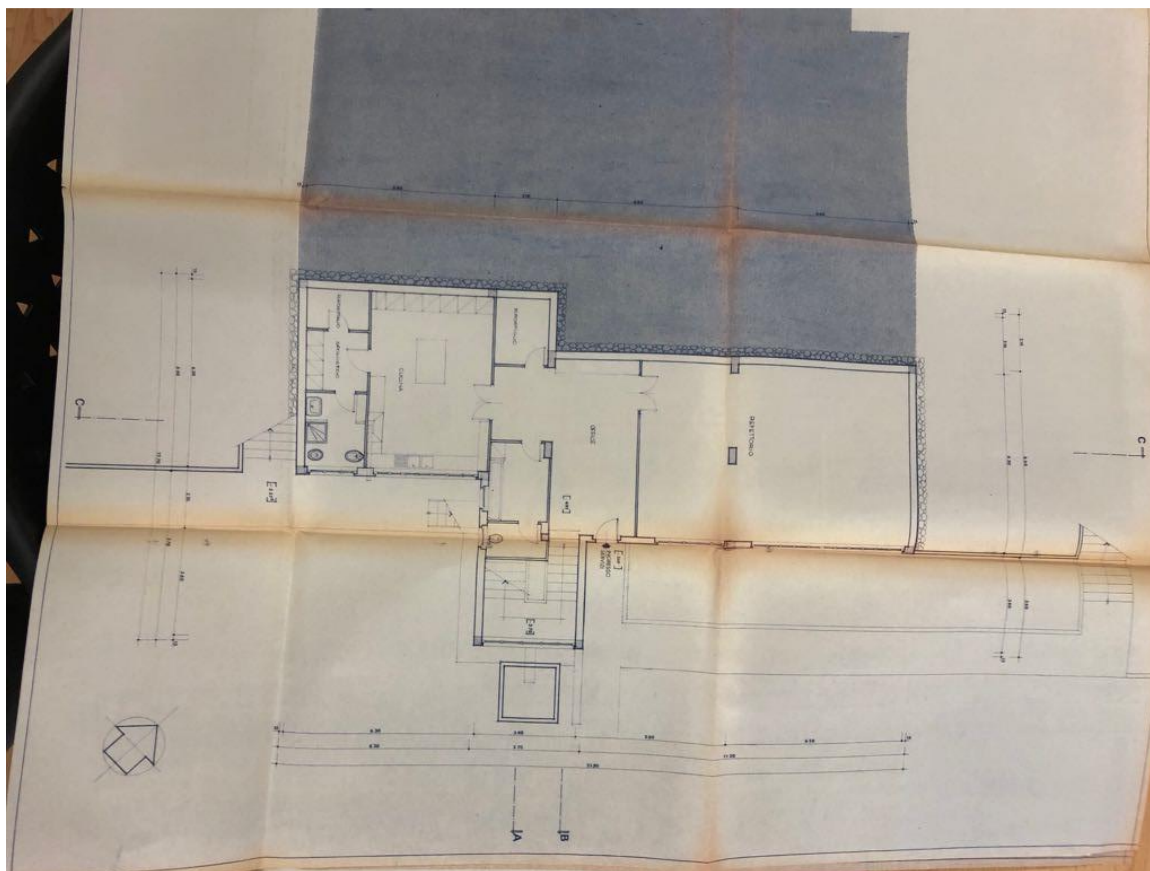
Pianta piano seminterrato (progetto architettonico – 1975)
